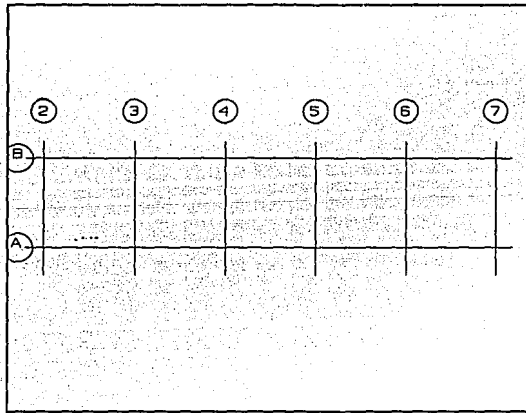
(b).- Modelo 3. Planta tipo
